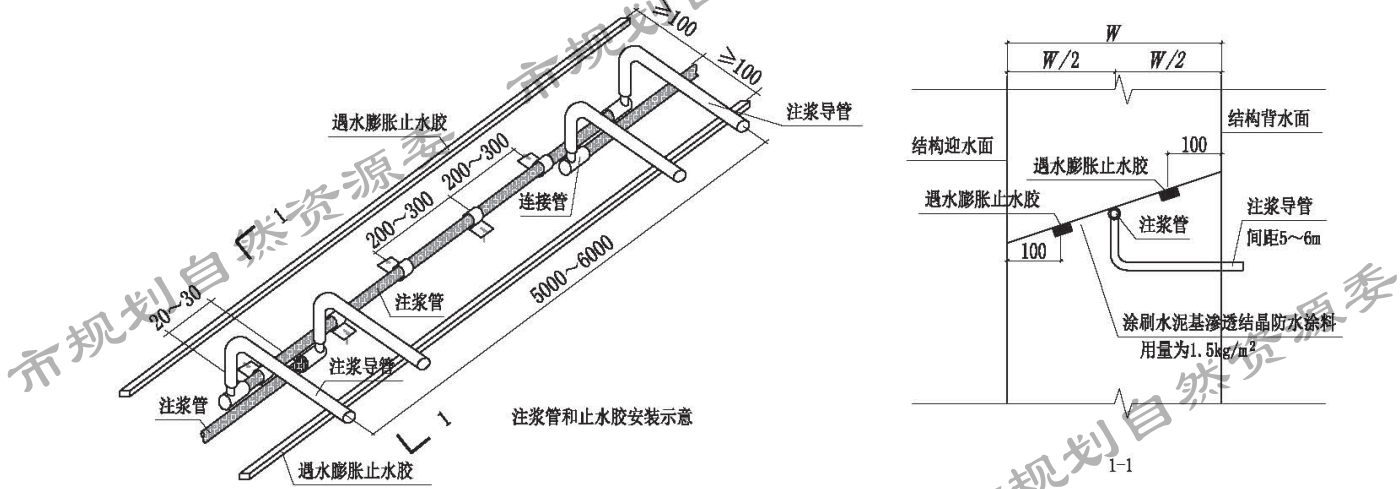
侧墙逆作连接节点施工缝防水构造示意
